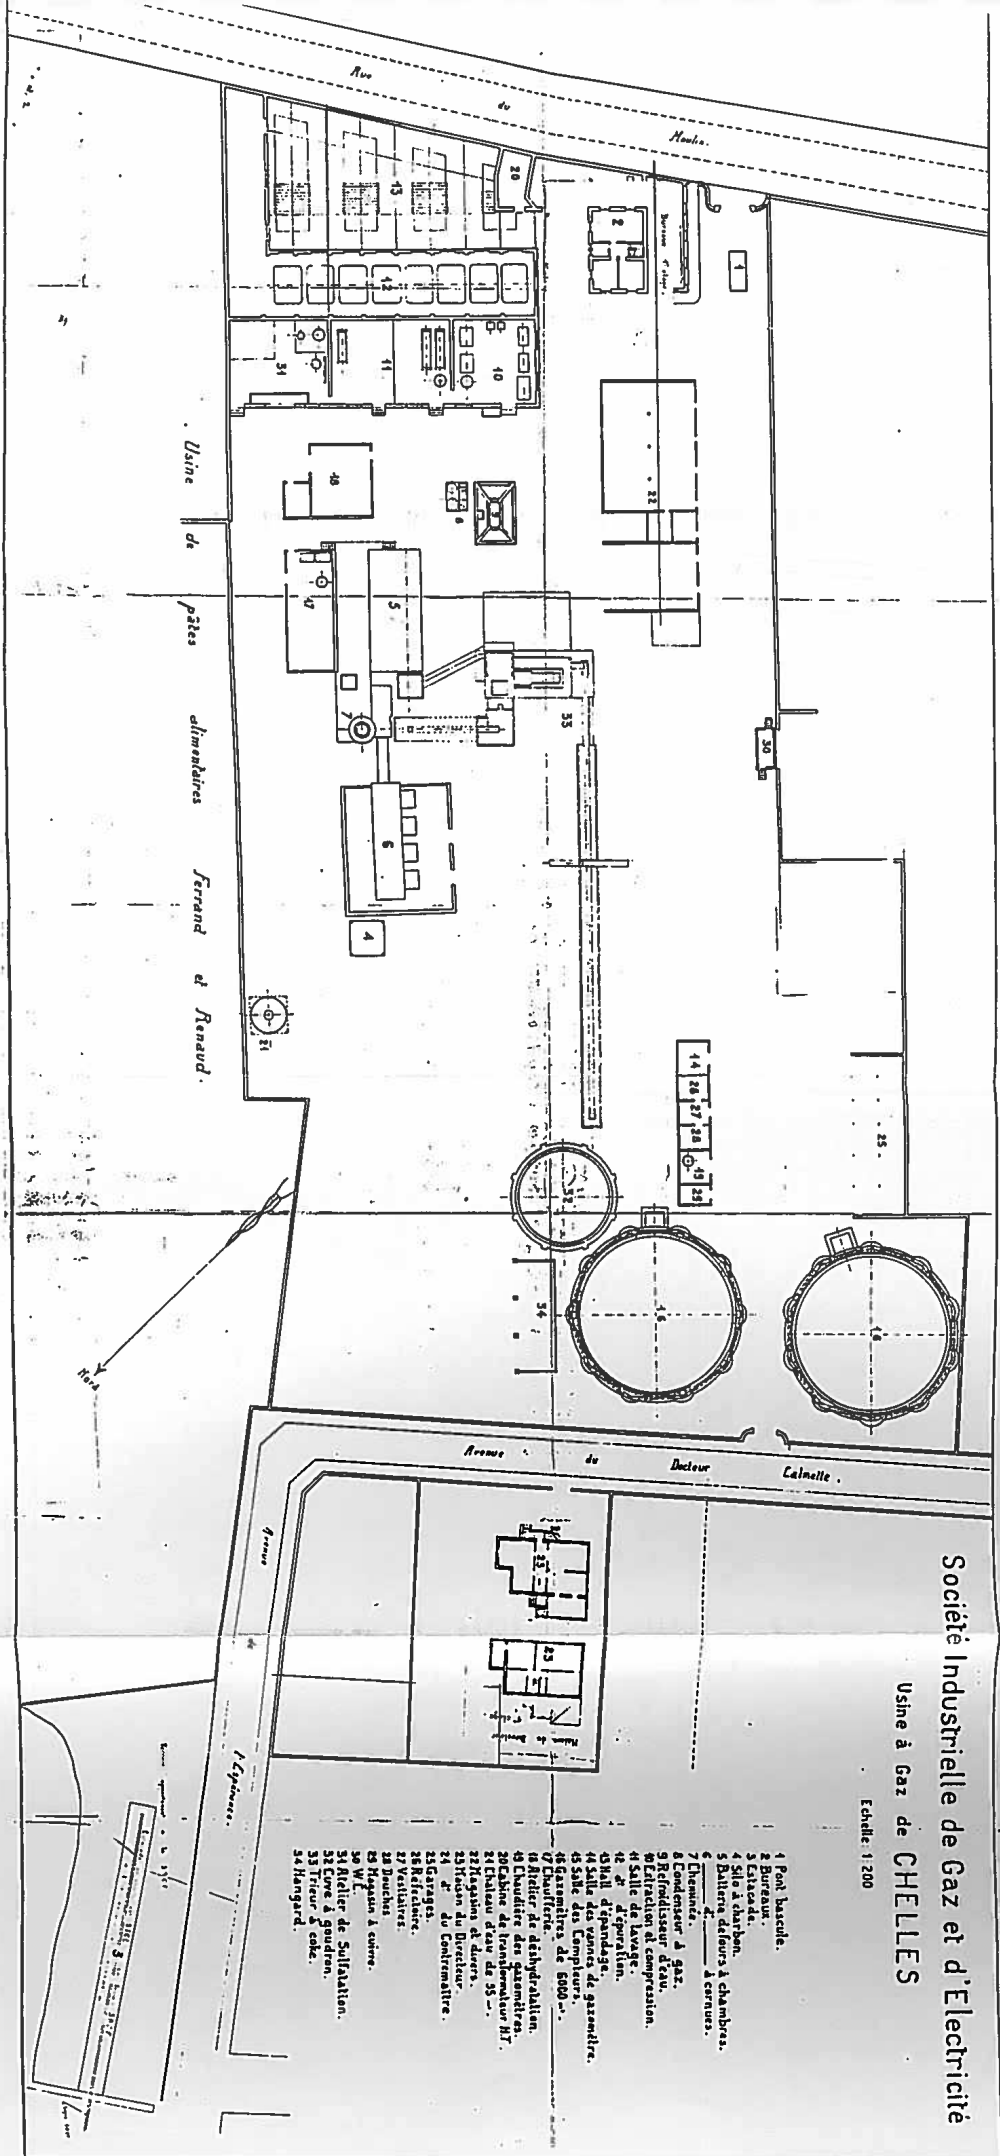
Plan entre 1934 et 1940 des installations de l'usine à gaz
